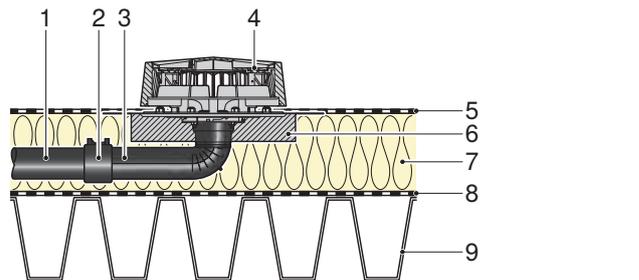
Монтаж на изолированной легкой кровле, горизонтальный выпуск в тепловой изоляции, с кровельным покрытием и пароизоляцией
